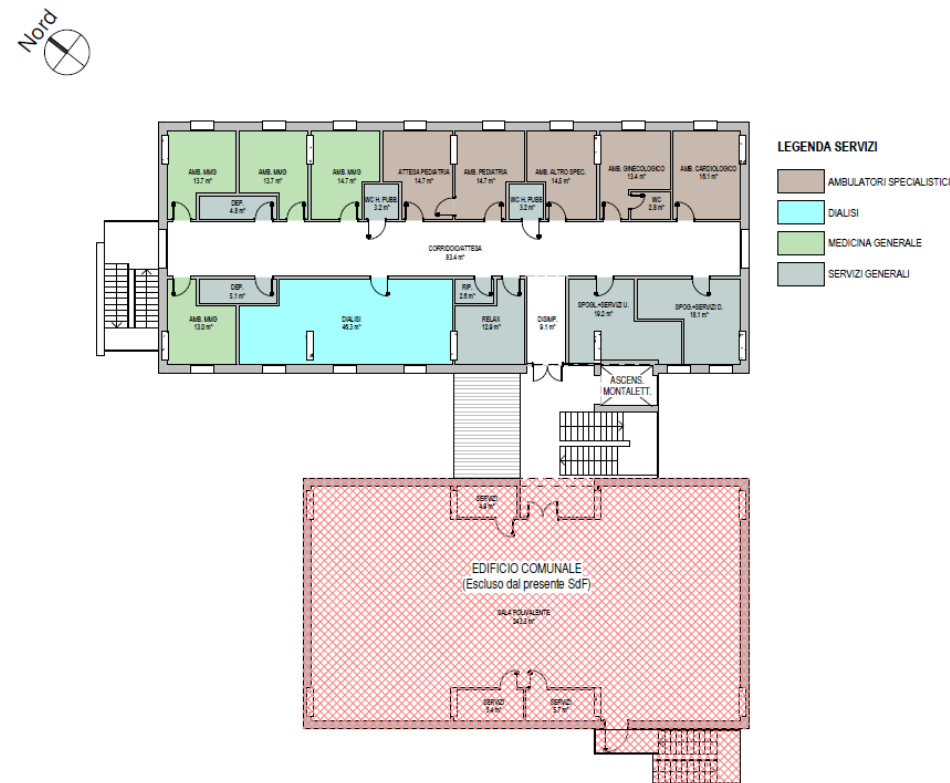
Pianta Piano Primo - Ipotesi di progetto
